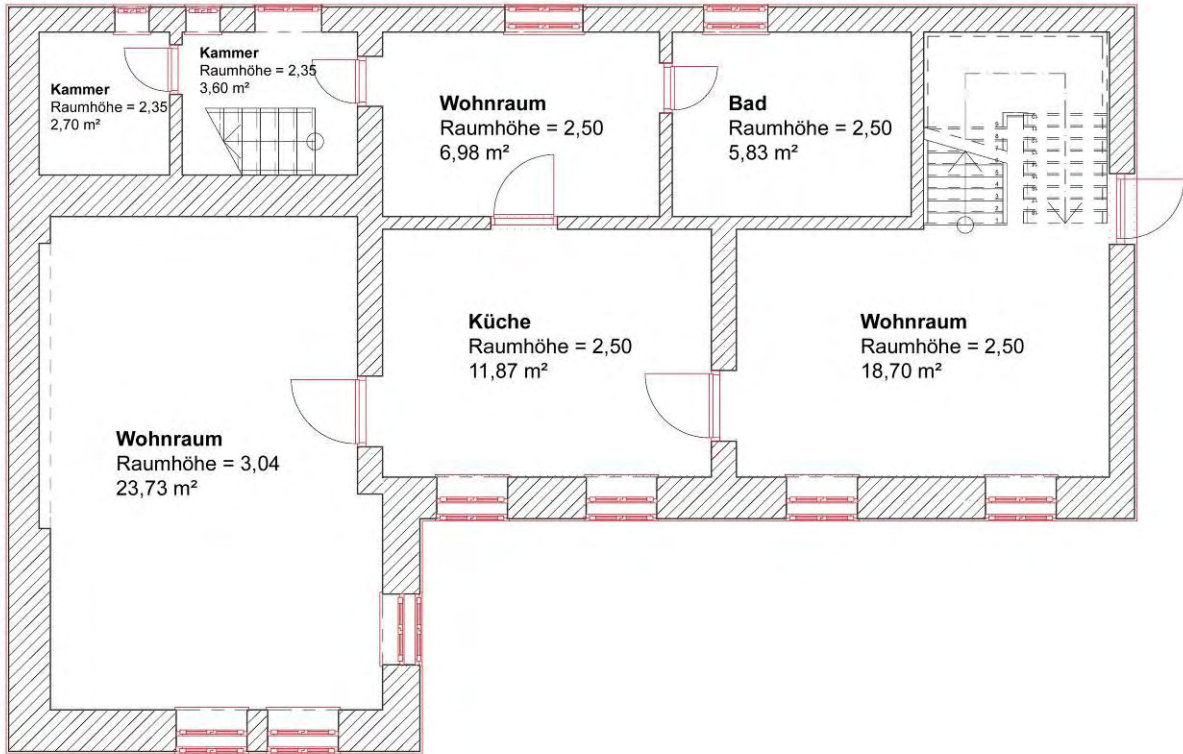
Grundriss Erdgeschoß (Bestand)
